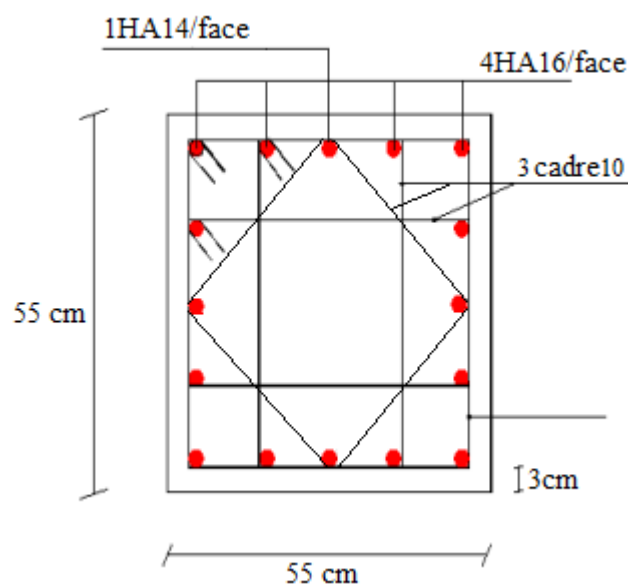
Schéma de ferrailage poteaux 2^{ème} étage+3^{ème} étage
